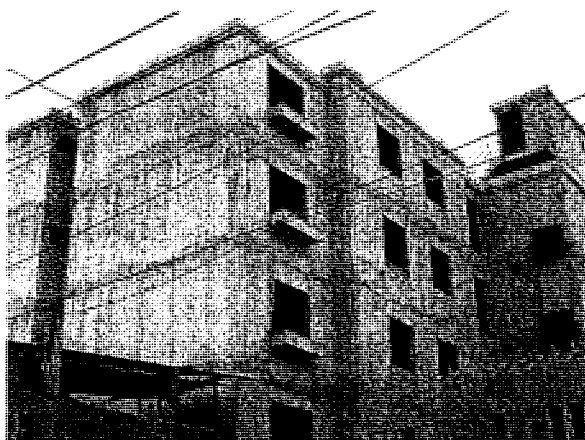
Edificio construido íntegramente de muros y losas macizas de concreto armado.
